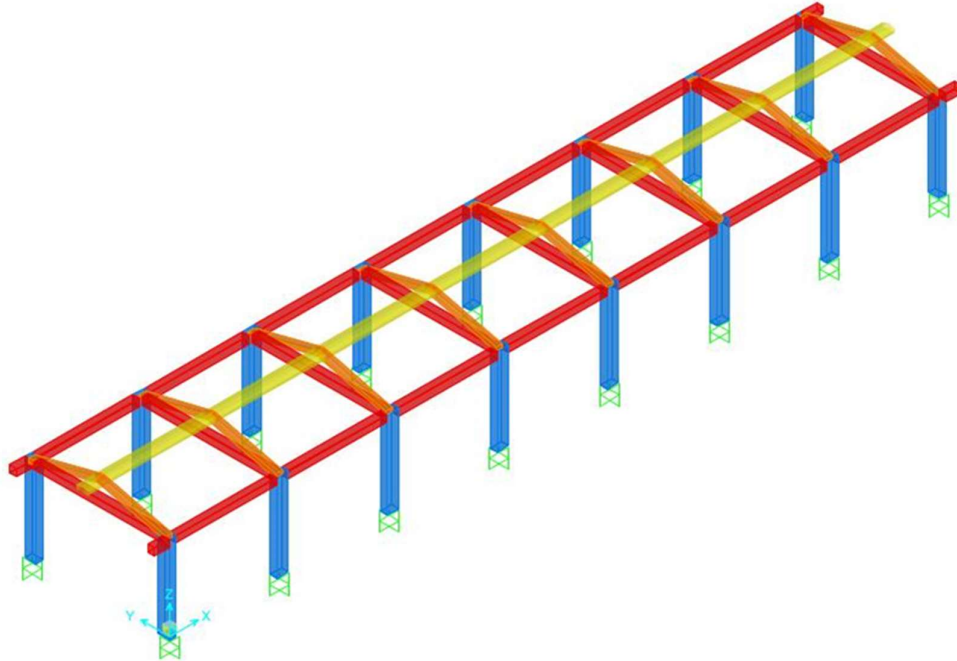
Vista assonometrica modello struttura in elevazione - elementi estrusi
